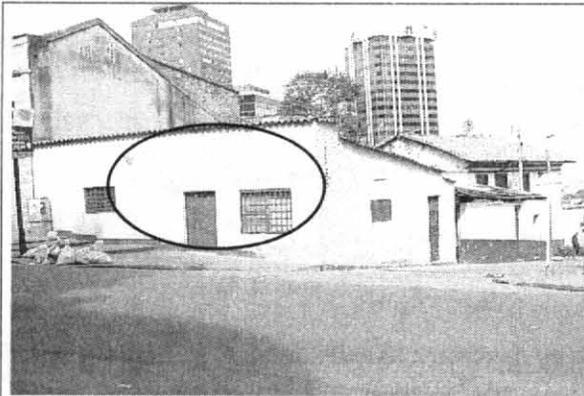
Condiciones de fachada al momento de la visita. Reparaciones superficiales de muro fachada sector oriental.
